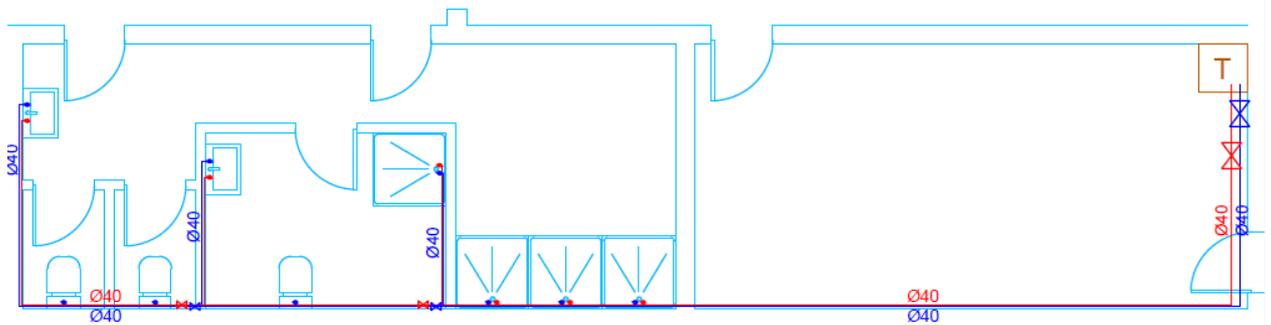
Detalle de la fontanería del baño. Elaboración propia
